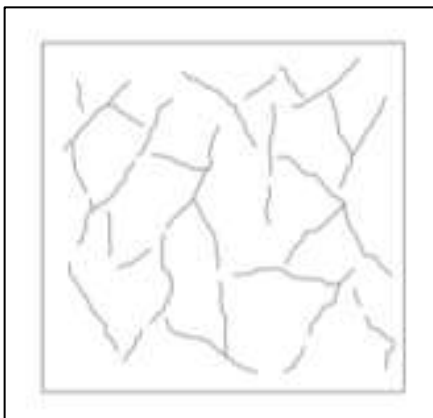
Representación típica de fisuración por retracción plástica
